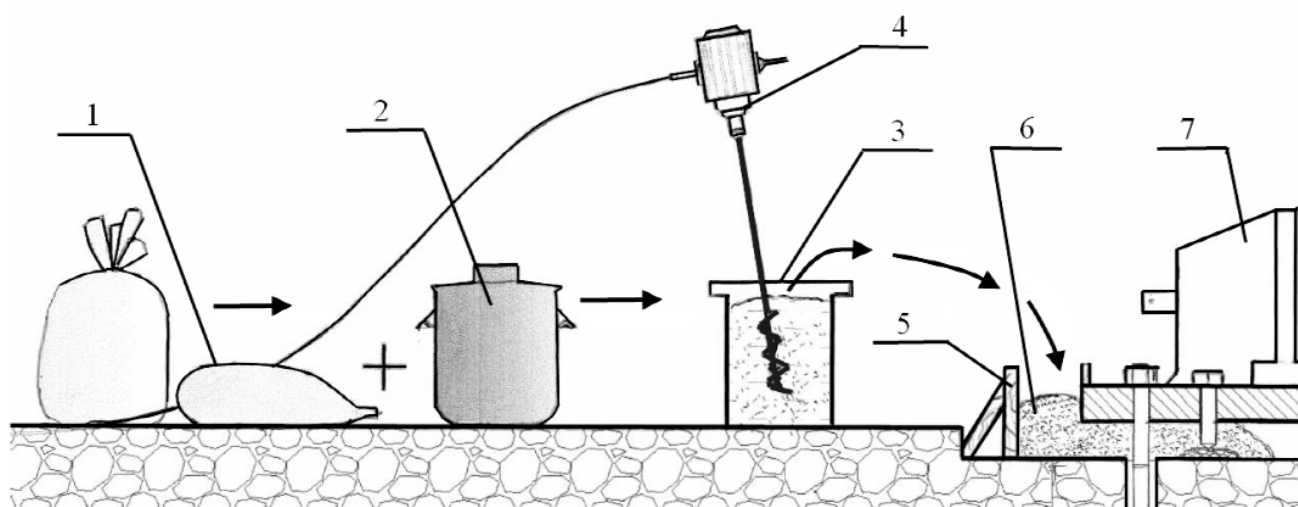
Один из вариантов технологической схемы устройства подливки: 1 — сухая подливочная смесь из фибробетона; 2 — емкость с водой; 3 — емкость для приготовления смеси; 4 — электроинструмент с лопастью-насадкой сложной геометрической формы; 5 — опалубка; 6 — смесь; 7 — оборудование
